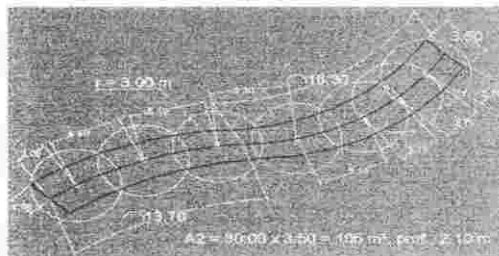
Vista de planta, distribución de los pozos para airear el área impactada A2.
